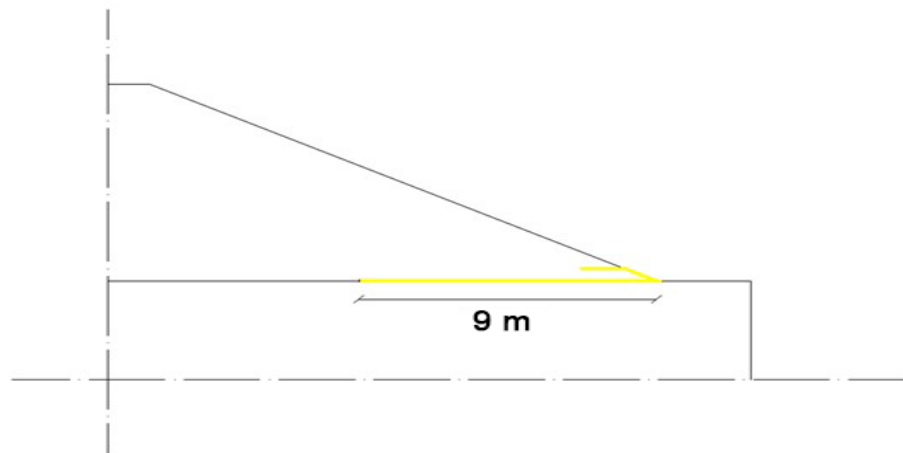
Detail Panjang Geotekstil Berdasarkan Perhitungan Stabilitas Terhadap Geser
